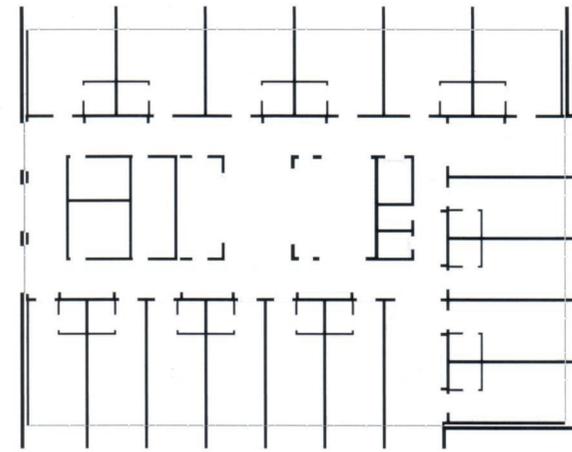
Grundriss 1. und 2. Obergeschoss M 1:500
